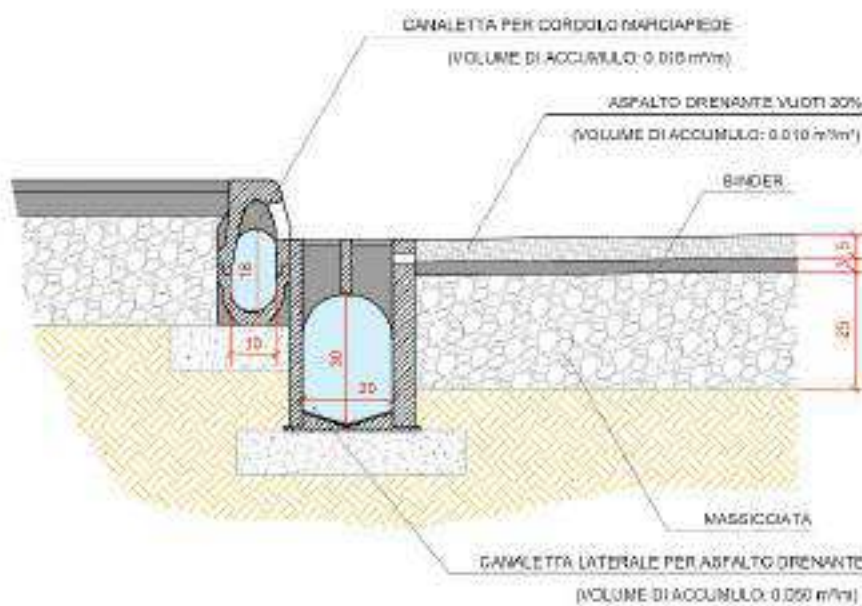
Stratigrafia pavimentazione stradale drenante
